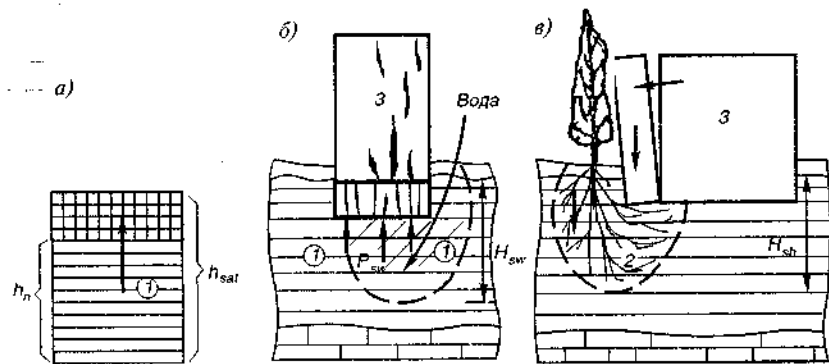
Схема набухания грунта (а), давление набухания (P_{sw}) на фундамент (б), деформация здания от усадки грунта (в):
